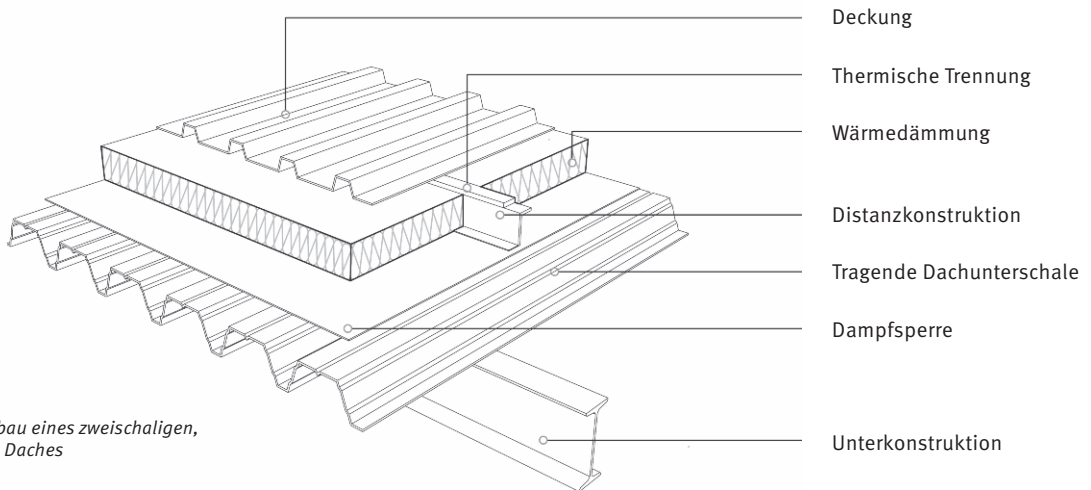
Konstruktionsaufbau eines zweischaligen, gedämmten, unbelüfteten Daches
